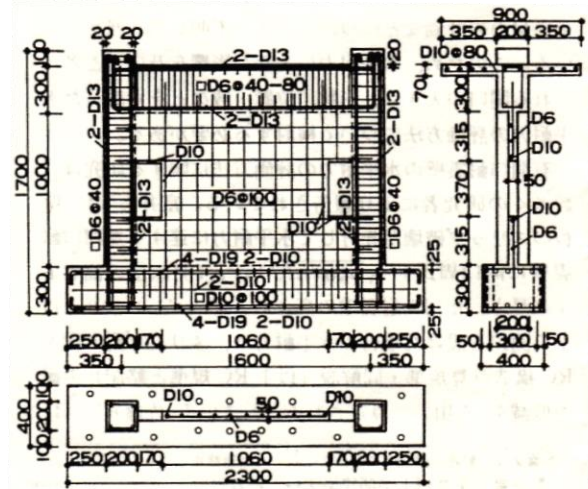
試験体の形状・寸法および配筋の一例 (FW5-0.261-D-CLR)<sup>32)</sup> (単位: mm)
